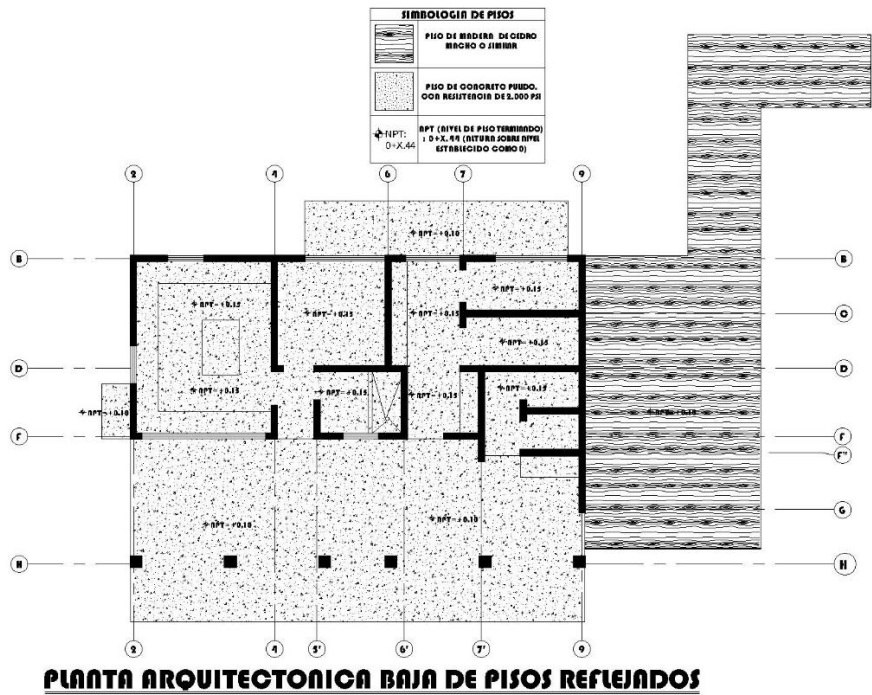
Planta Baja de Pisos Reflejados. Resedo.
